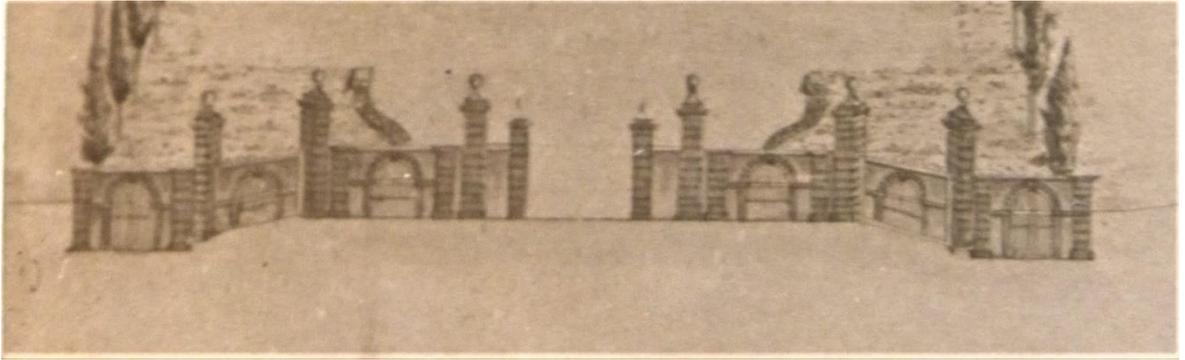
1830, Saverio Andreucci, particolare del muro di cinta prospiciente la strada pubblica, da *Prospetto della Villa detta la Fidelia*, in Perugia, BAAS, Archivio Fotografico. Si riconoscono con facilità i sedici pilastri e i cinque vani interrotti da cancelli irremovibili.
